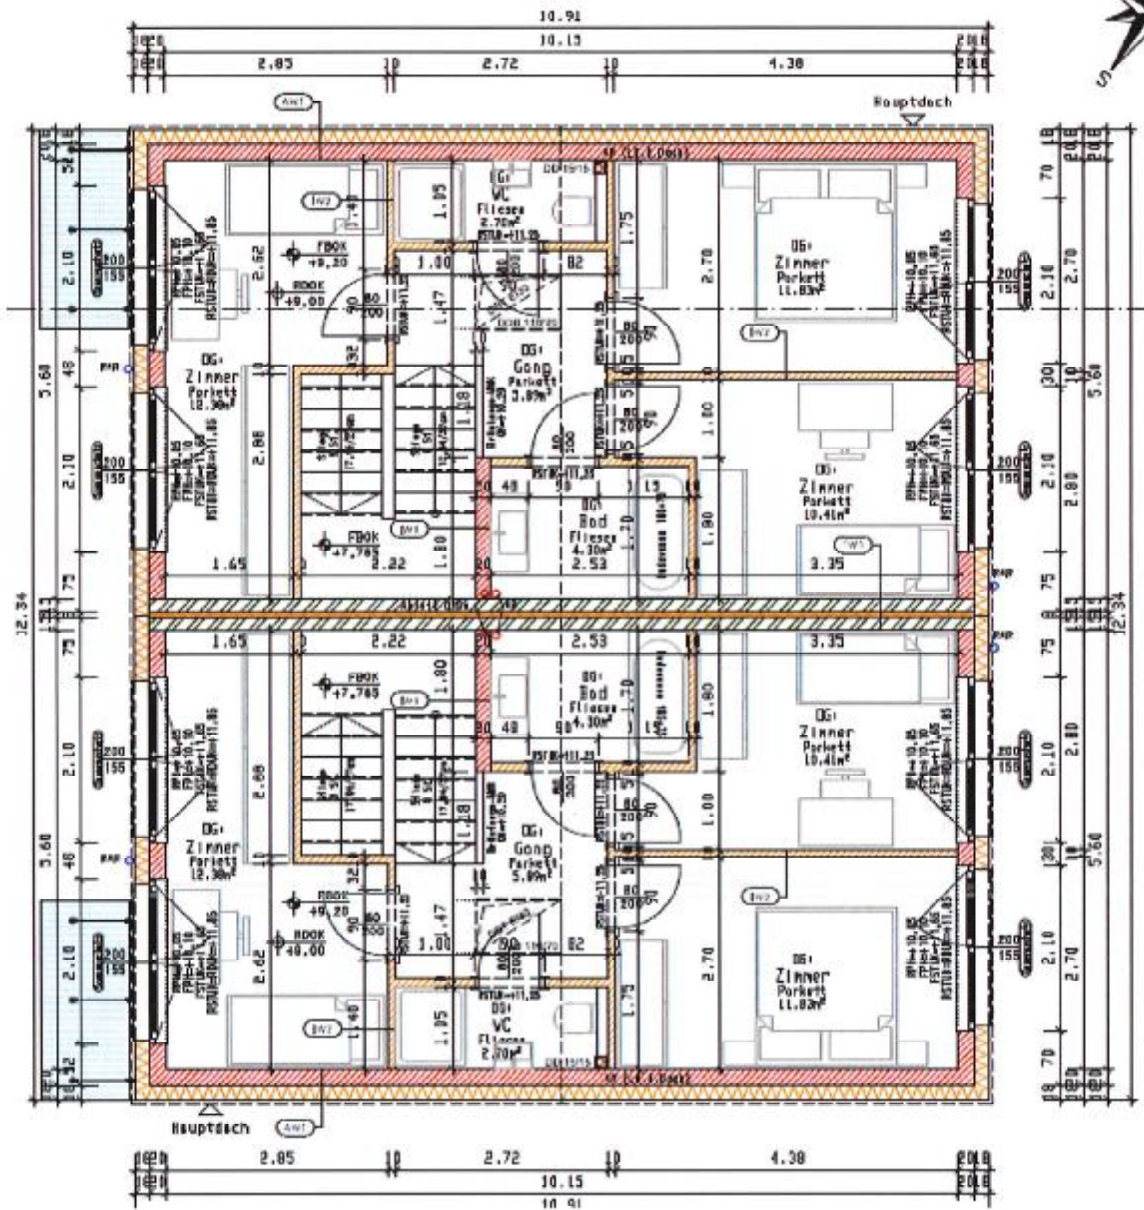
Grundriss 1. Obergeschoß Doppelhaus 2 | 21.10.2021
